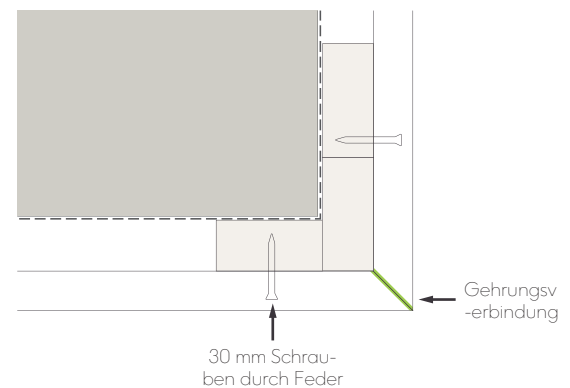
Details der auf Gehrung geschnittenen Außenecke
